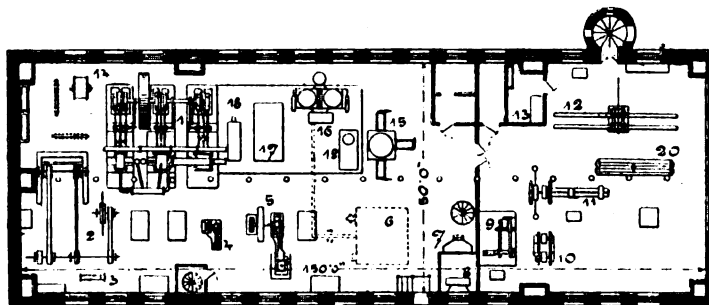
Grundriss vom Erdgeschoss.
